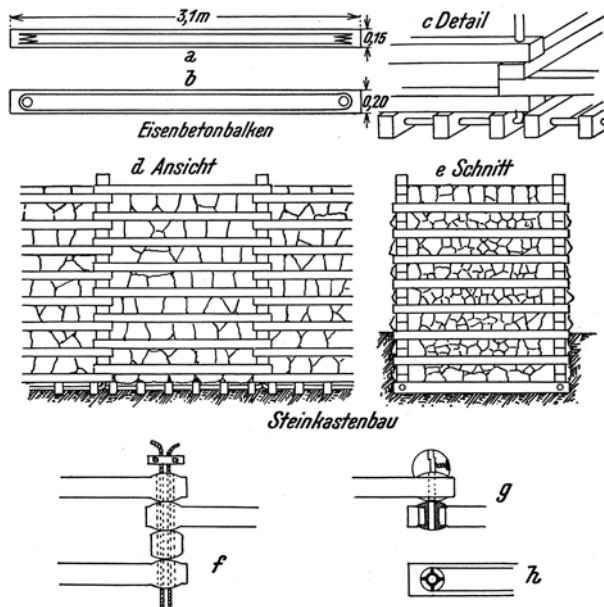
Eisenbetonsteinkasten nach Ing. Andreocci.
